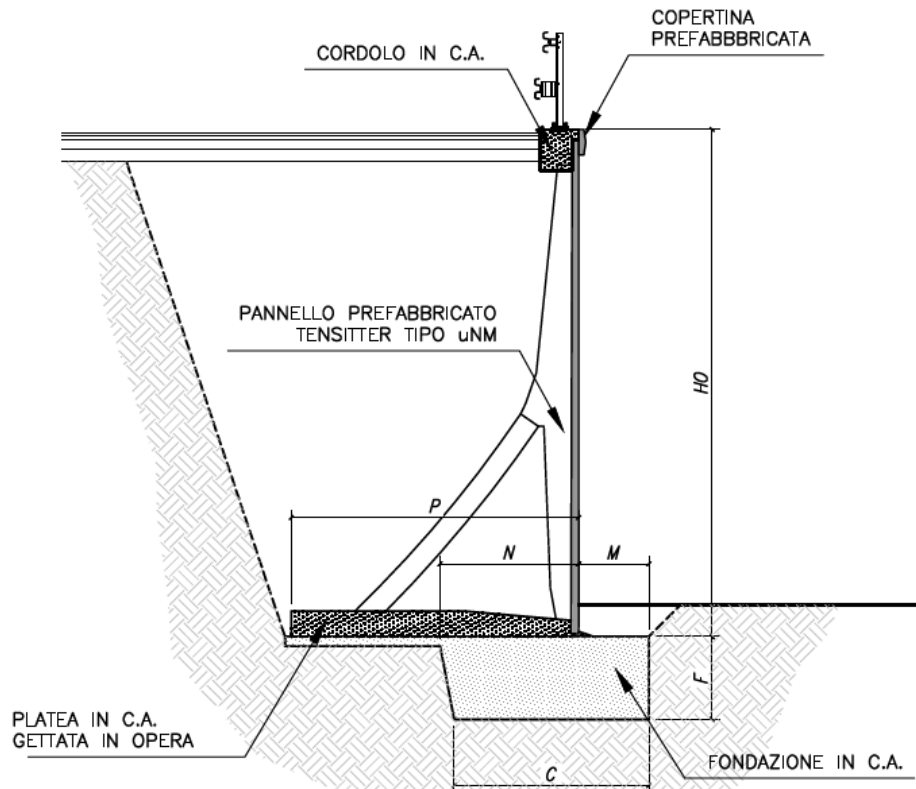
Sezione tipologica muro prefabbricato di tipo "uTM"
